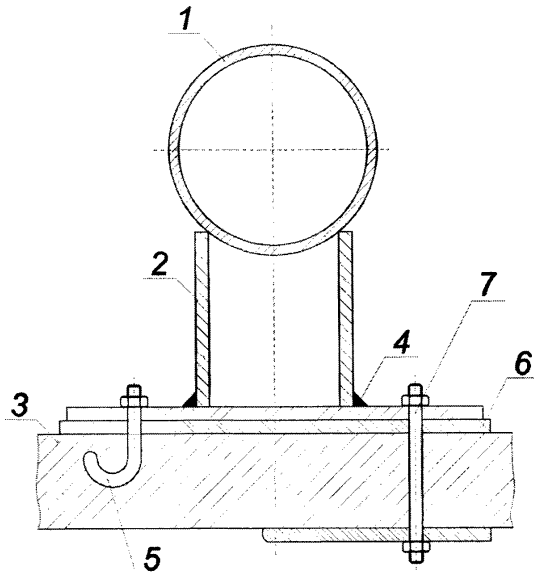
Пример назначения границ между опорными конструкциями и строительными конструкциями
